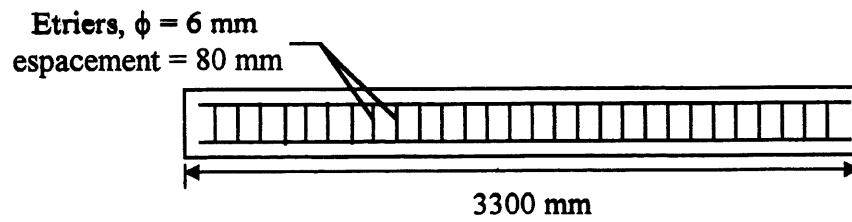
Détails de renforcement des poutres des séries 1 et 2
